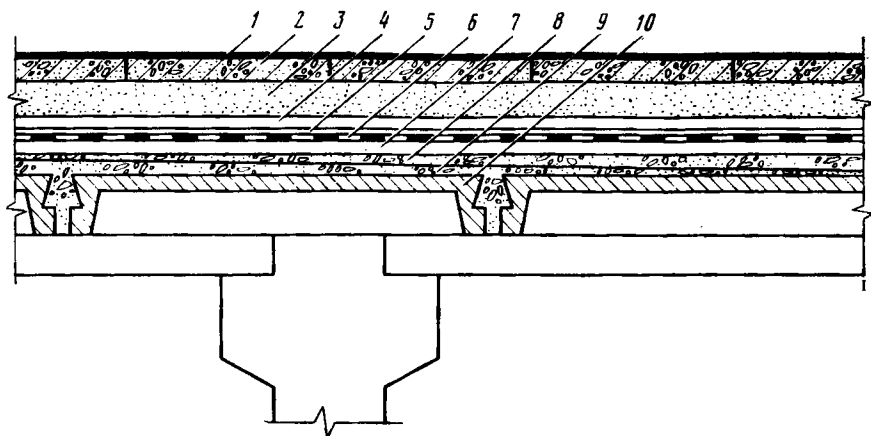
Конструкция покрытия вертолетной площадки на крыше здания:
